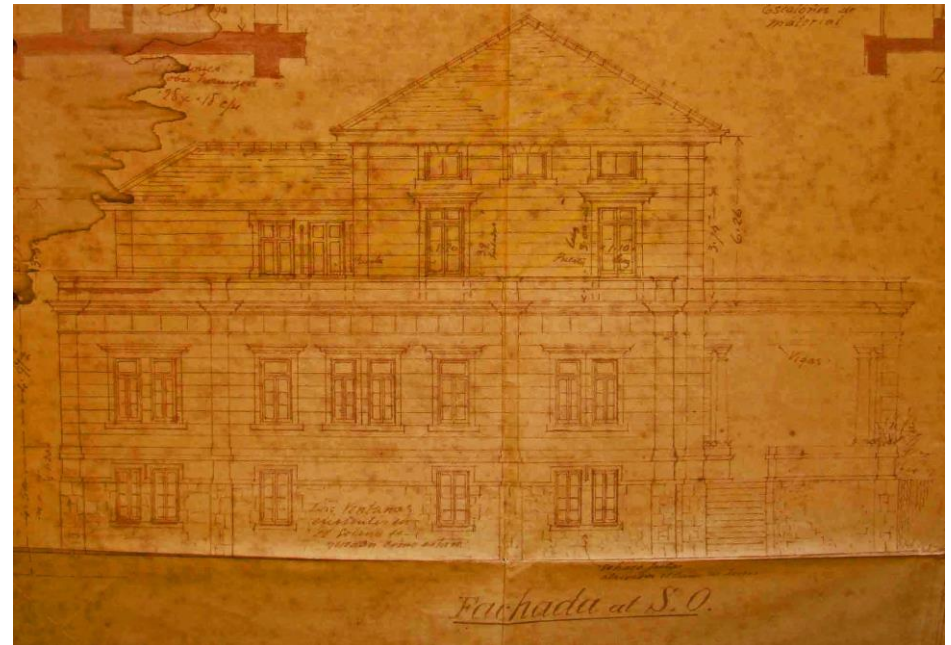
Fachada sudoeste, 27-03-1918. Acervo: Clube Campestre.
